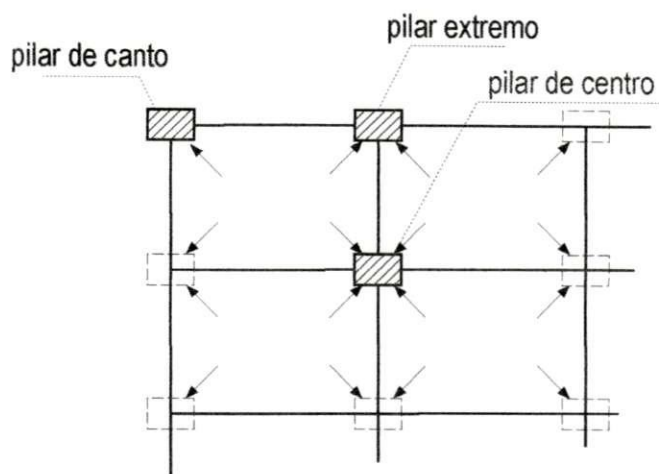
Distribuição do carregamento nos pilares de um edifício.
